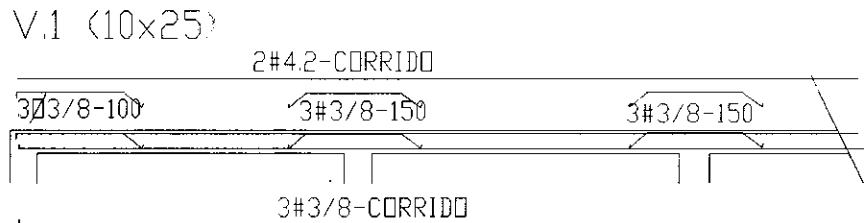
Detalhe da viga V1 da estrutura da creche.
